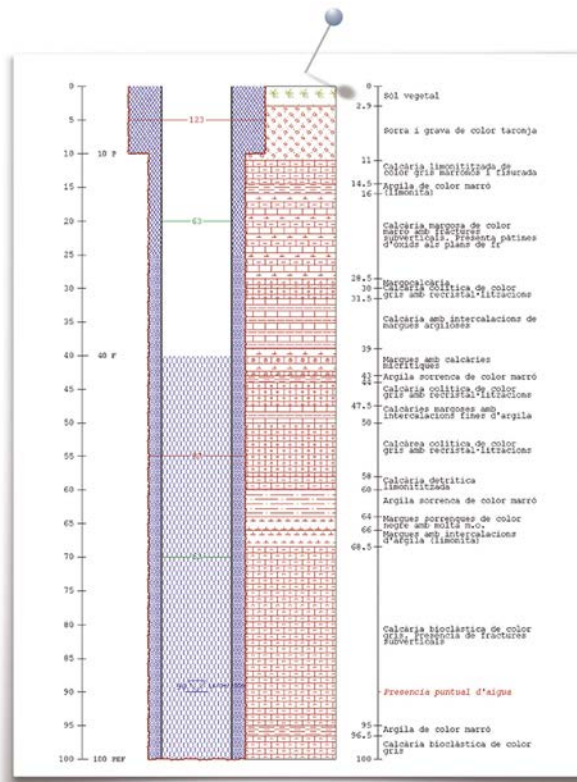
Exemple d'esquema constructiu d'una captació.
